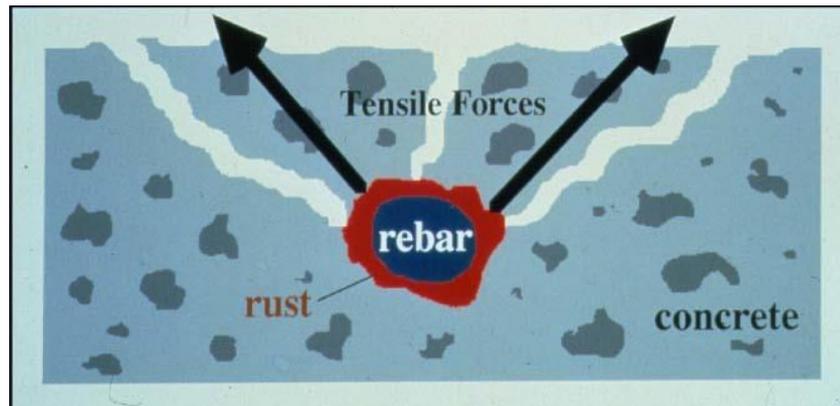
Mecanismo de fisuración, debido a los esfuerzos de tensión generados por la hinchazón del acero de refuerzo afectado por la corrosión.
